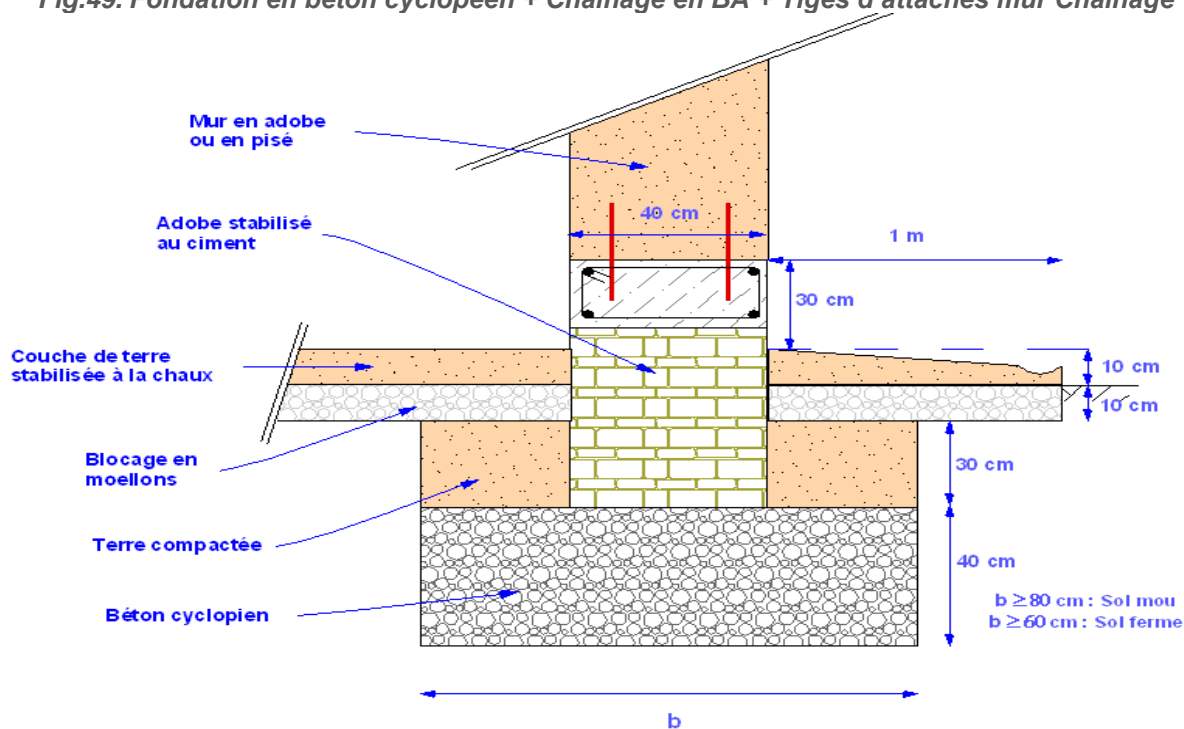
Fondation en béton cyclopéen + Chaînage en BA + Tiges d'attaches mur Chaînage
